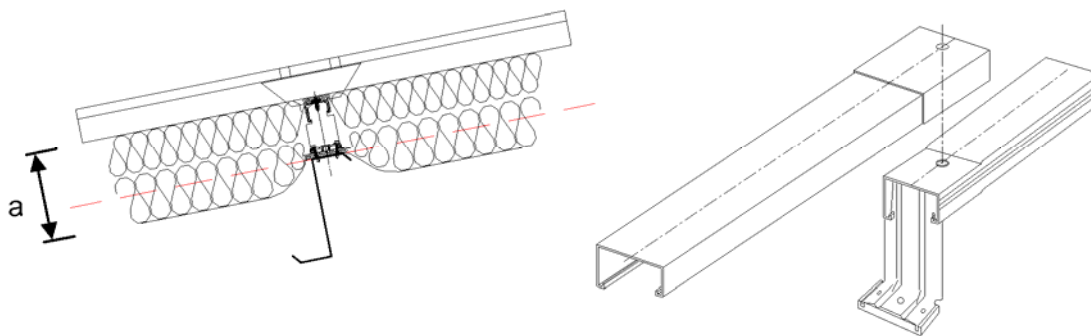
EINSCHALIGES DACH MIT AUFSTÄNDERUNGSKONTSRUKTION (Bridge System)
